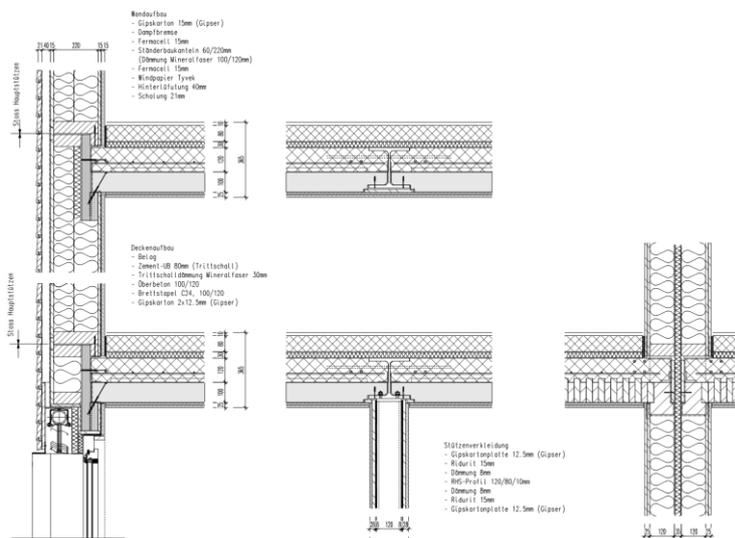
Auf dem Skelett-/Rahmenbau aufgebaute Standarddetails in Kombination mit Stahlträgern als Unterzugsystem und mit Holzbeton-Verbunddecken.
